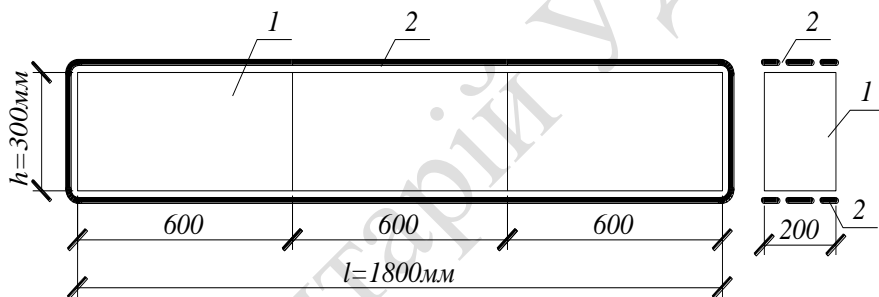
Схема перемычек из трех газобетонных блоков без перевязки швов
